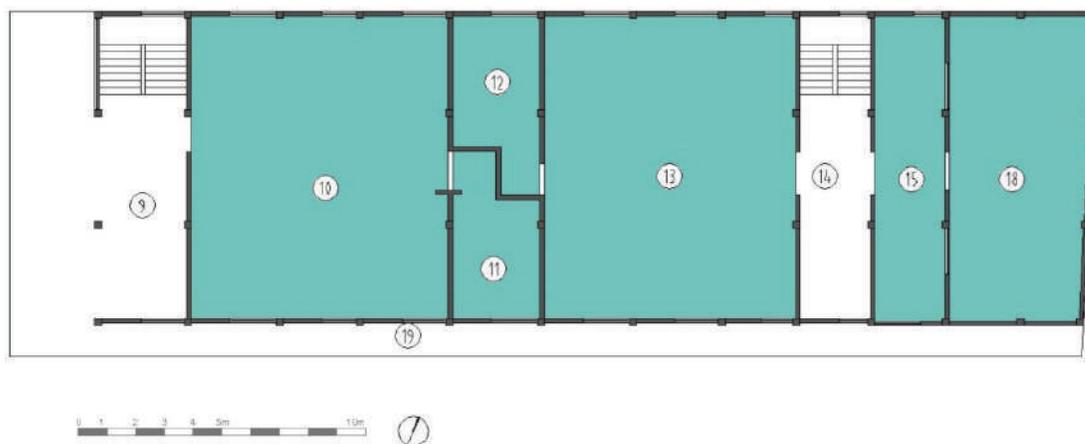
Planta 1 Bloque 26. Fuente: Equipo de diagnóstico
